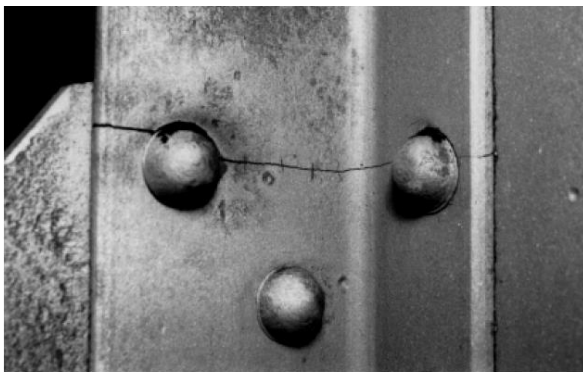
Fisuras en detalles de vigas principales de puentes.
